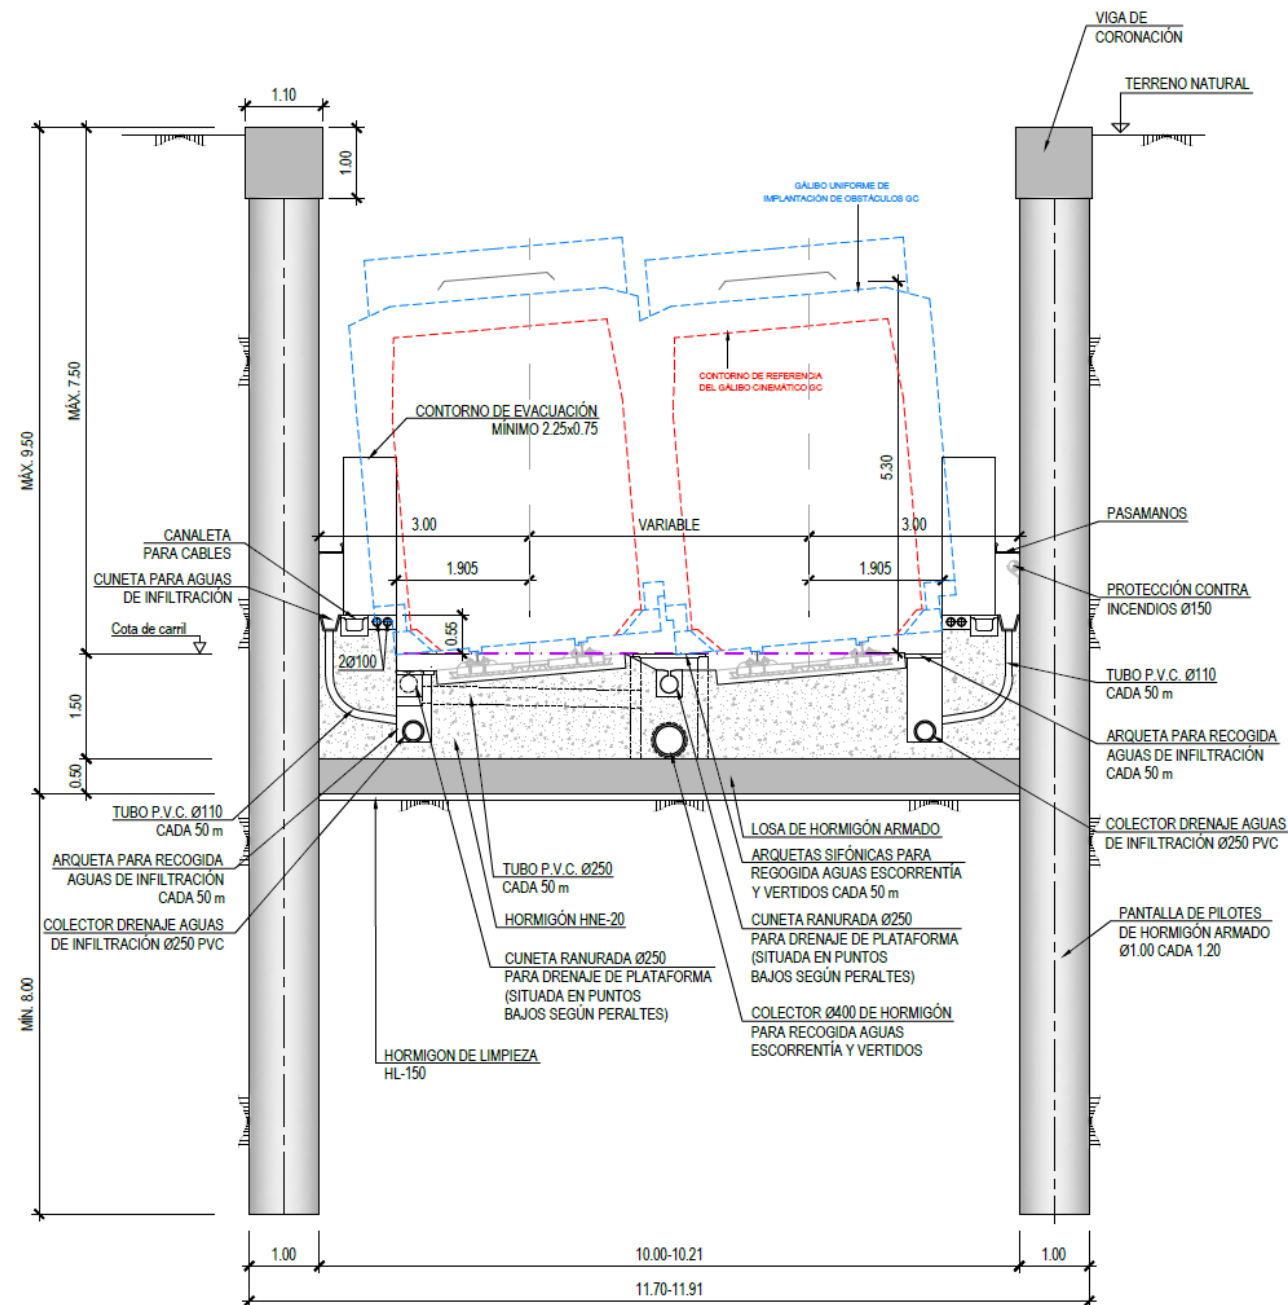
b.- Sección tipo 2 en rampas (ST-R2).
